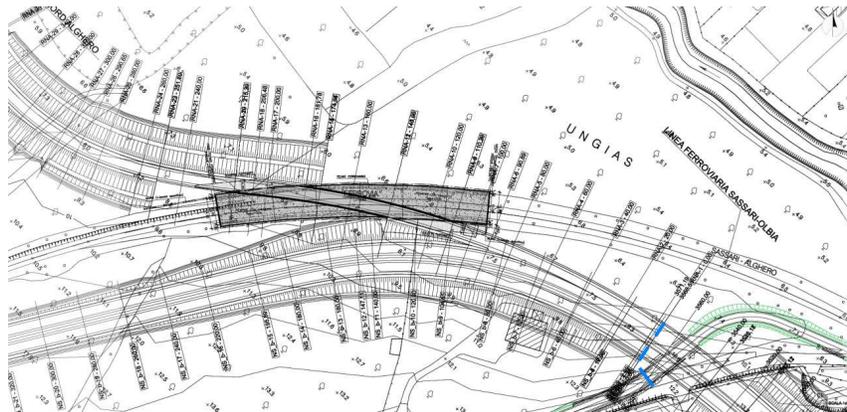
Planimetria - Galleria artificiale ferroviaria "A"
